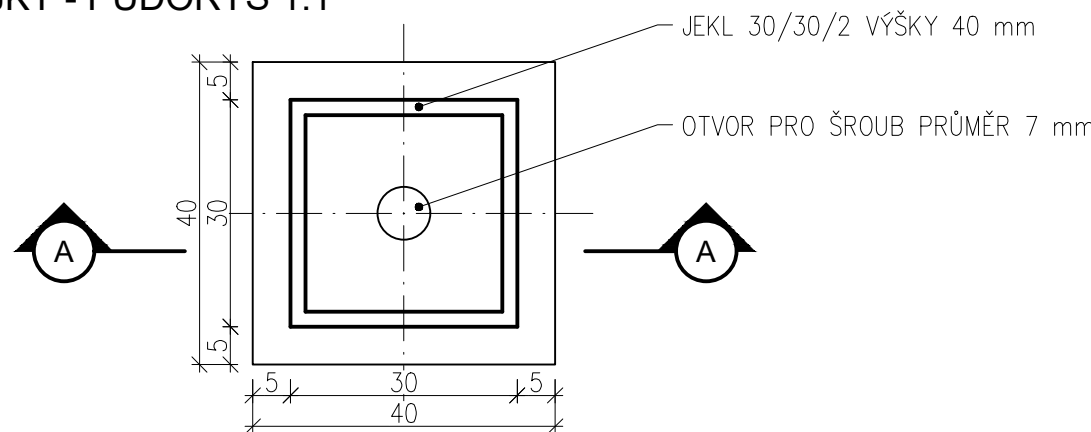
KOTVENÍ PLNÉ VÝPLNĚ DO RÁMU - PŮDORYS 1:1
